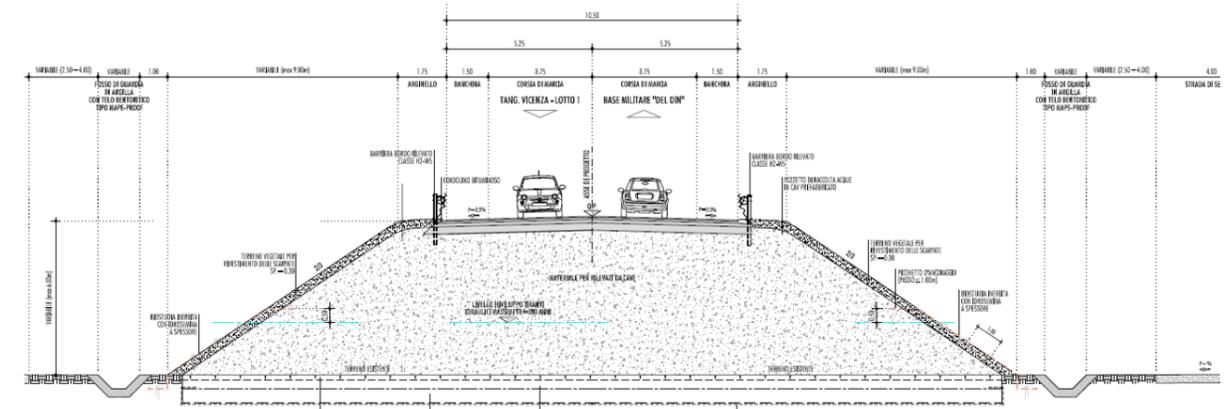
SEZIONE TIPO IN RILEVATO
